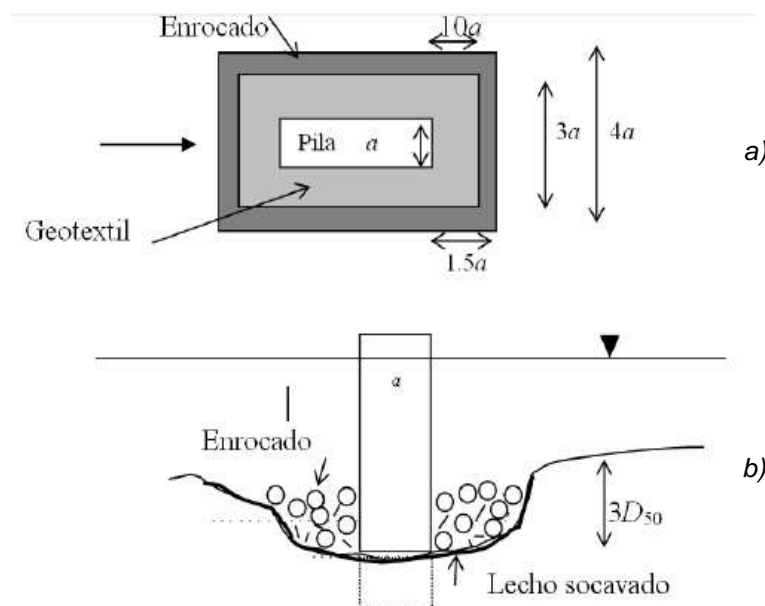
Enrocado colocado en excavación previamente hecha, a) Planta ( $\varnothing=0^\circ$ ), b) Sección transversal. SAFL. 1998
